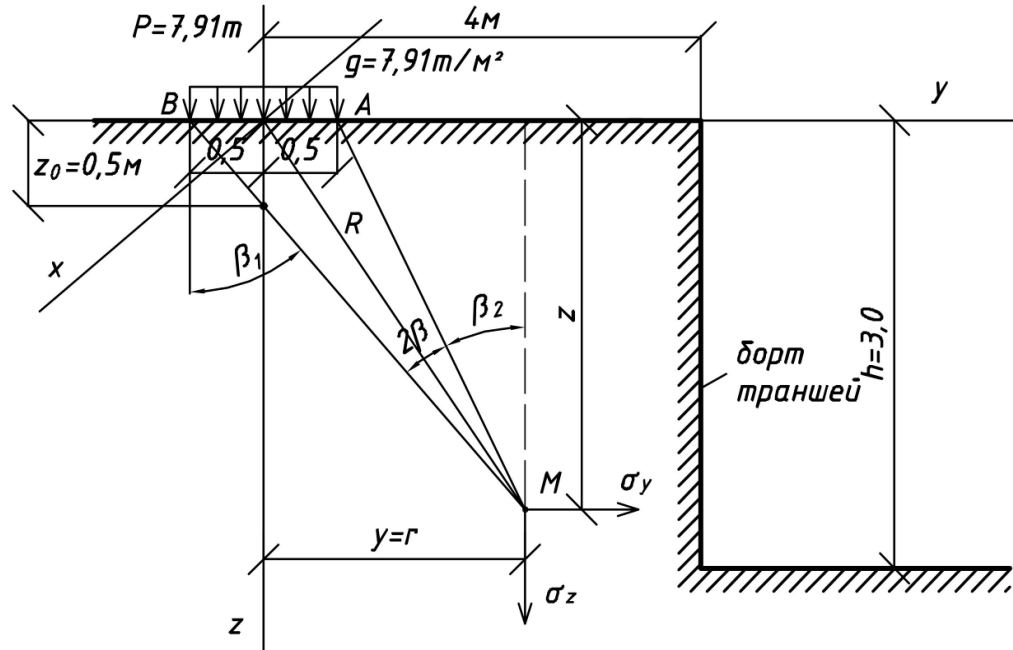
Расчётная схема передачи нагрузки от опорной подушки наклонного модуля на грунтовое основание
